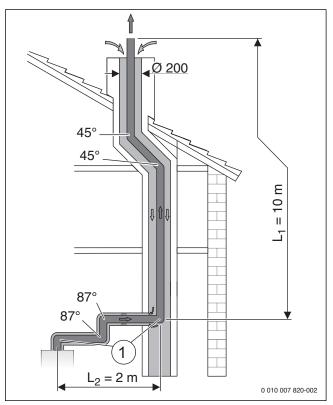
Einbausituation einer Abgasführung im Schacht nach  $C_{93x}$
